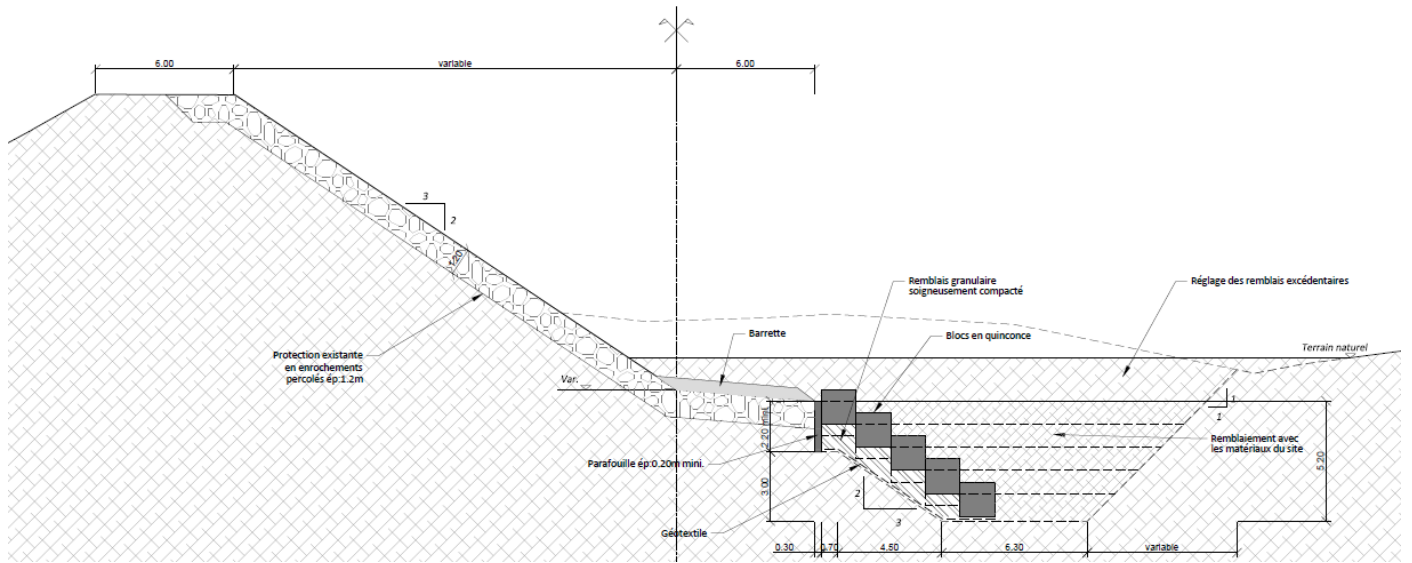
PROFIL TYPE DU RENFORCEMENT DE LA DIGUE - ©BRLINGENIERIE
